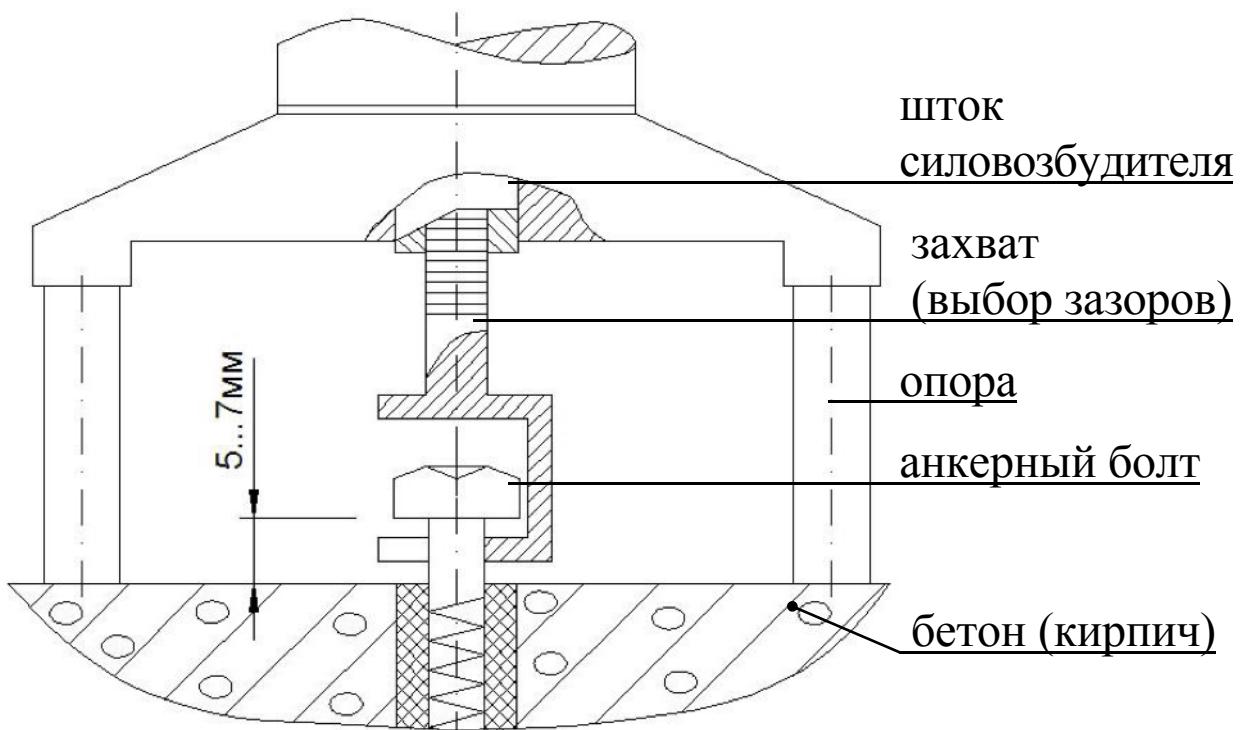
Схема подготовки прибора ПСО-МГ4А к измерениям
